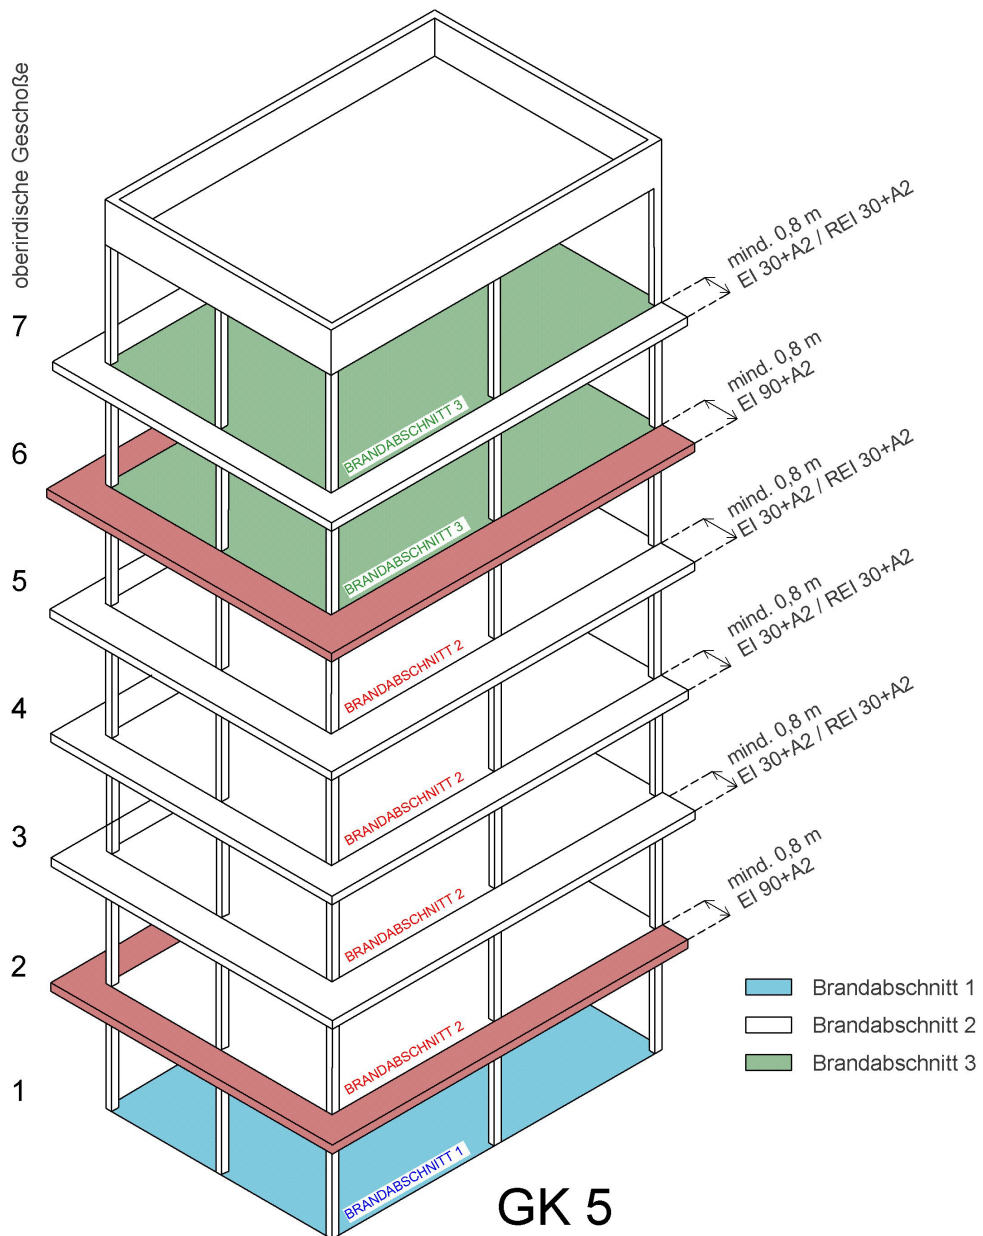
zu den Punkten 3.3 und 3.1.7 – ausragender Bauteil bei GK 5 bzw. ausragender Bauteil bei Brandabschnitten
